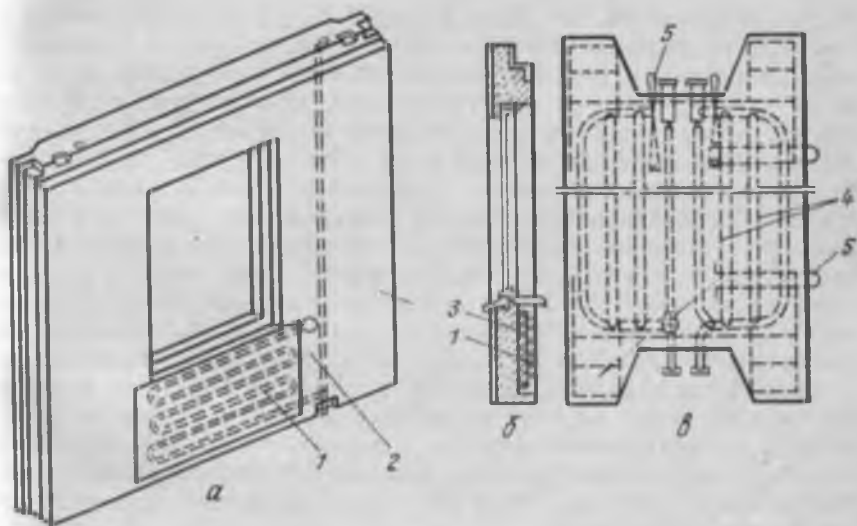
Крупные стеновые бетонные панели с заделанными в них нагревательными приборами из стальных труб:
